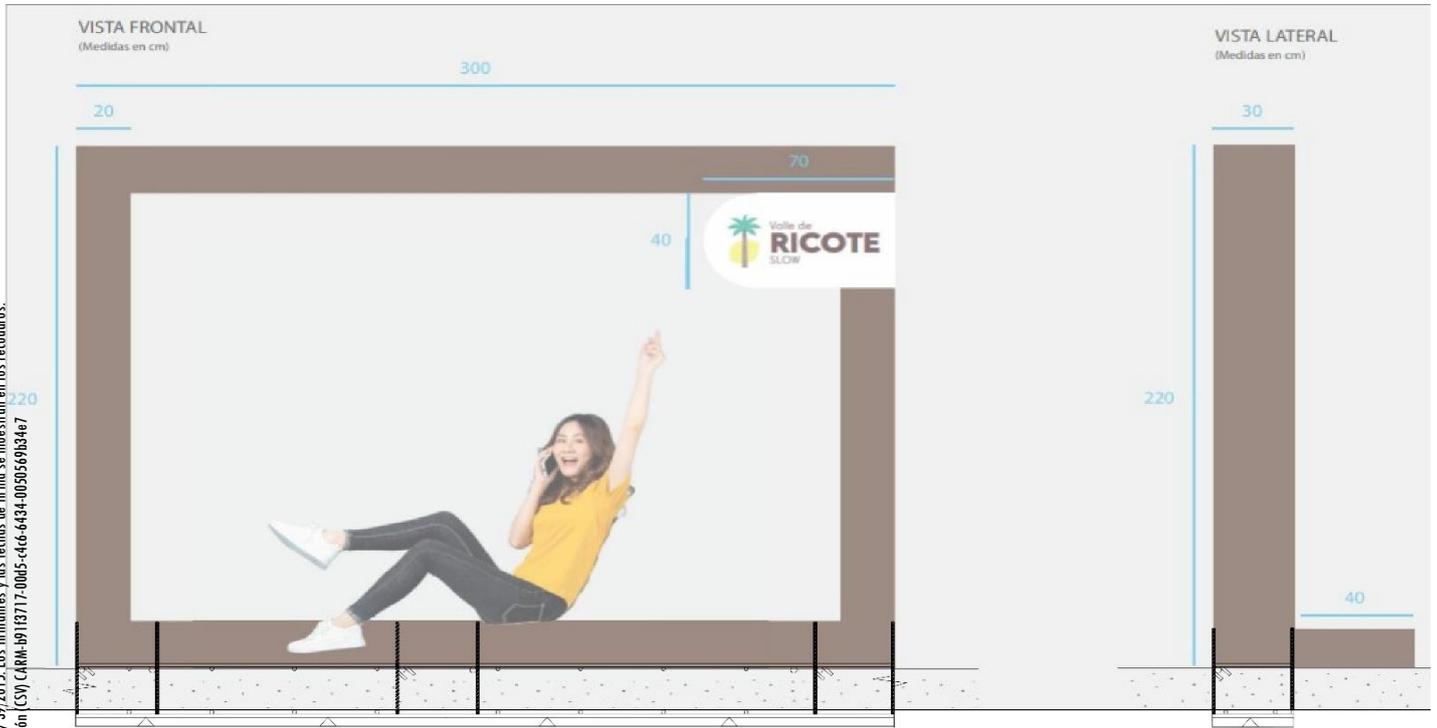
Detalle cimentación en Losa Prefabricada y Anclajes a Photocall
